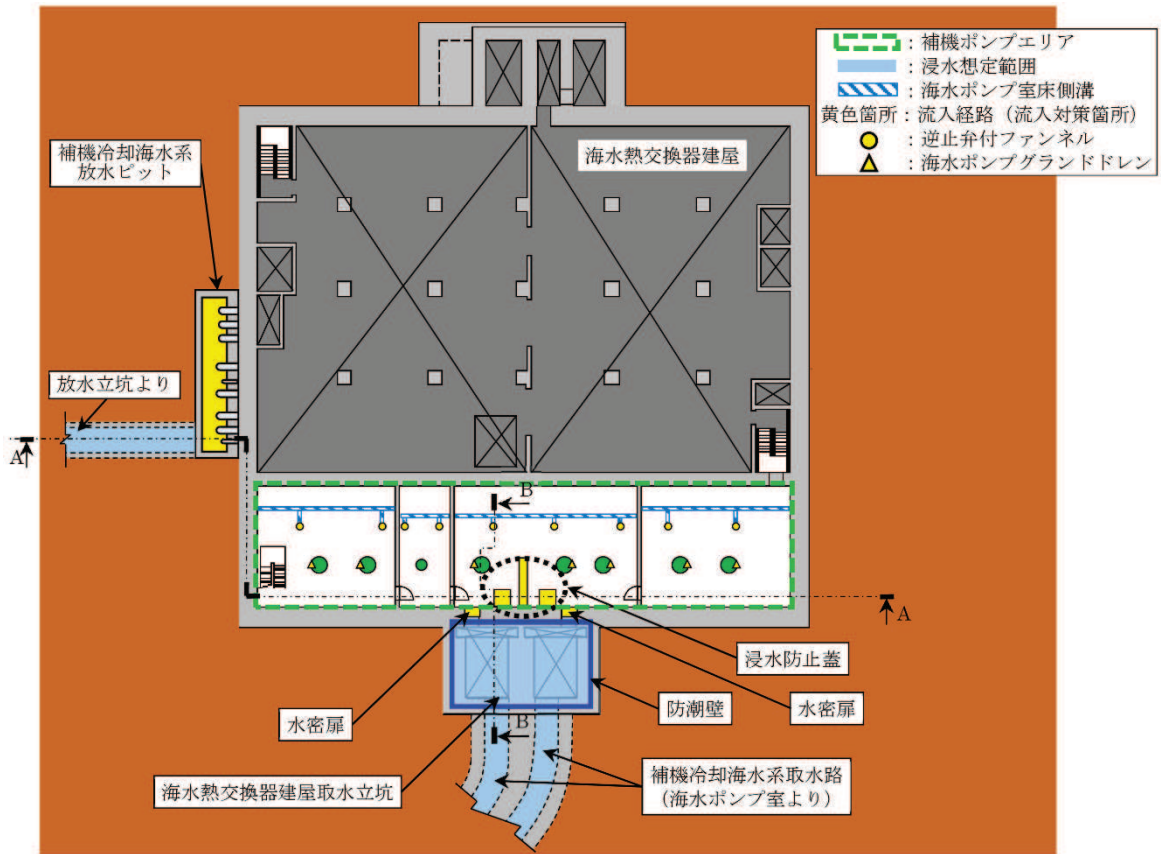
3号機 海水熱交換器建屋 流入対策配置図 (平面図)
